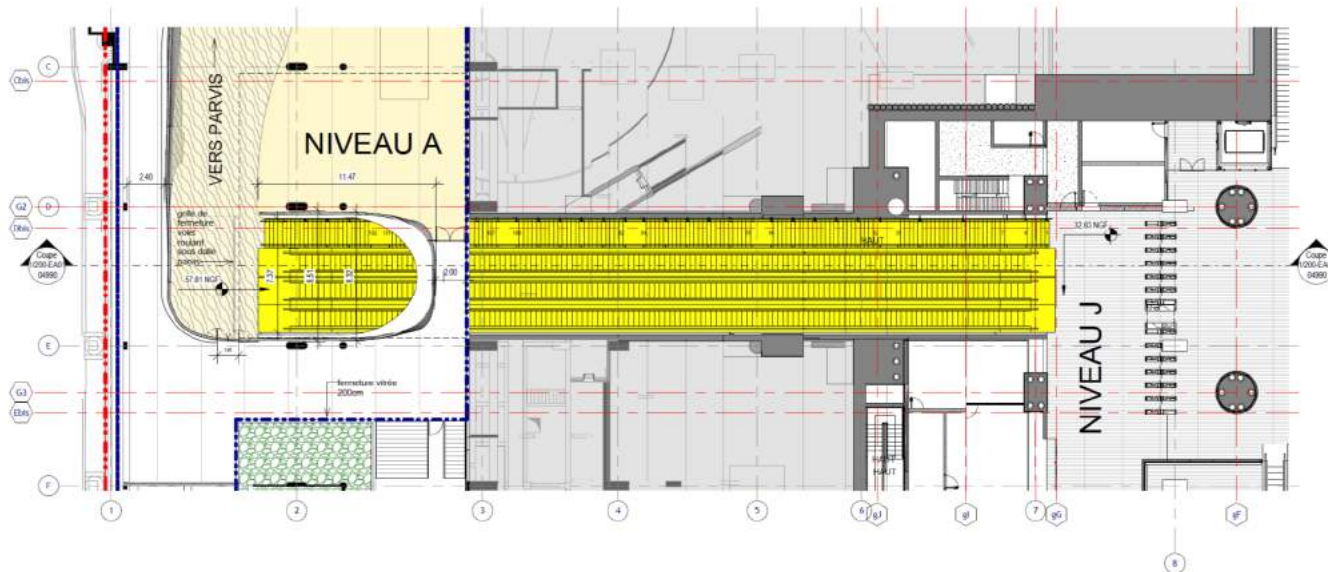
Plan du niveau J au niveau de la cour anglaise
